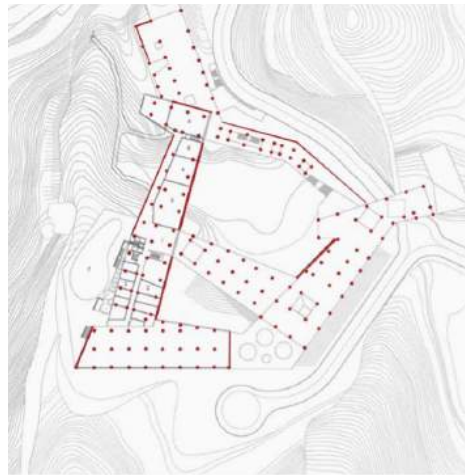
Estructura mixta: columnas de hormigón y muros portantes.
